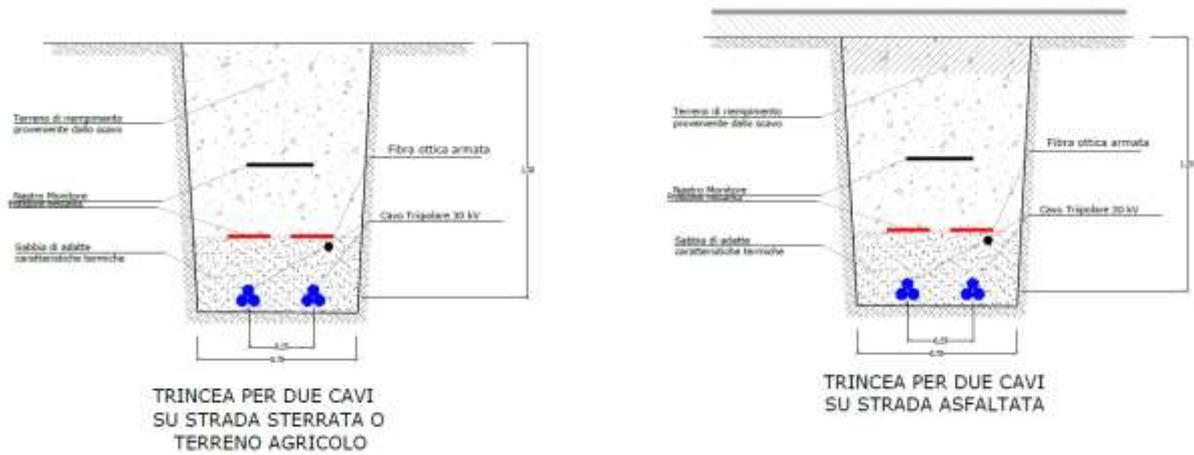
Sezione della trincea di scavo per la posa di n. 2 cavi da 30kV di collegamento dall’impianto FV alla Stazione di Elevazione – su strada sterrata o terreno agricolo e su strada asfaltata
